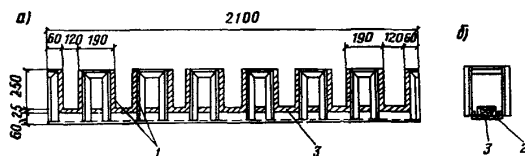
Гребенка для перевозки балок со стенкой прямоугольного сечения
